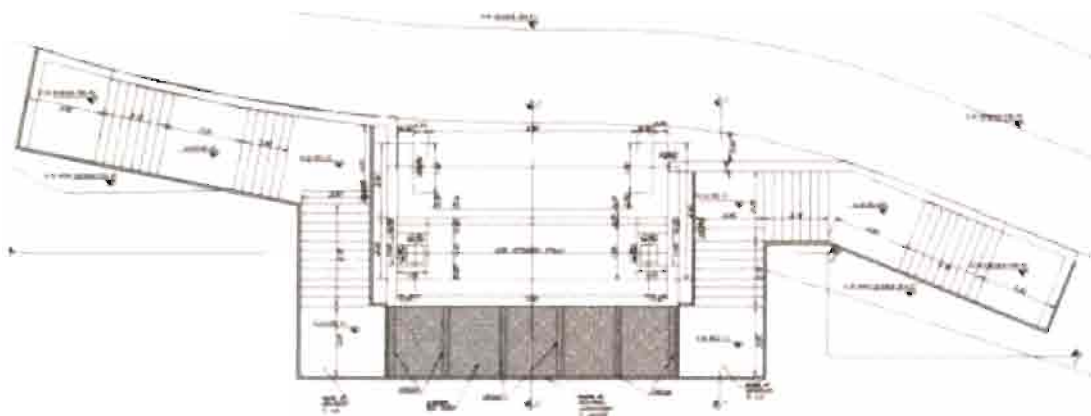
Grundriss Treppe an Eisack-Brücke
